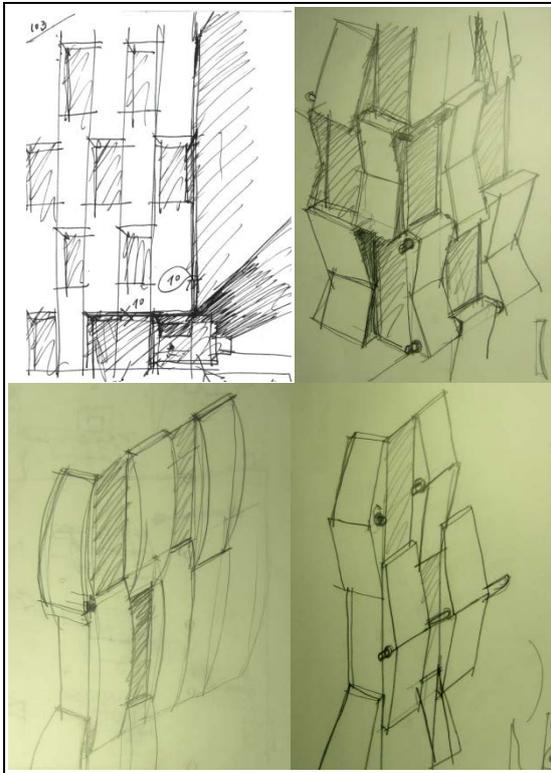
Esquiços de ESM do pormenor da fachada do Conjunto de La Pallaresa
